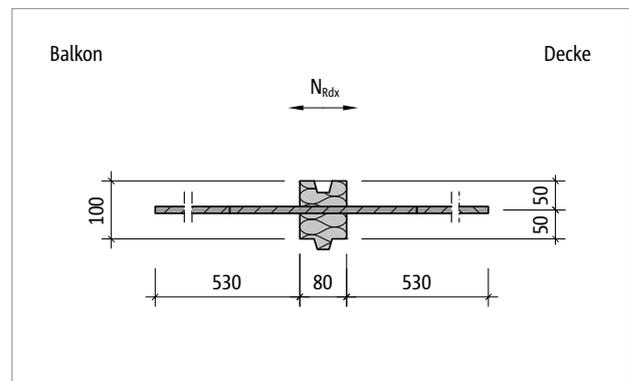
Schöck Isokorb® T Typ HP-NN2: Produktgrundriss
